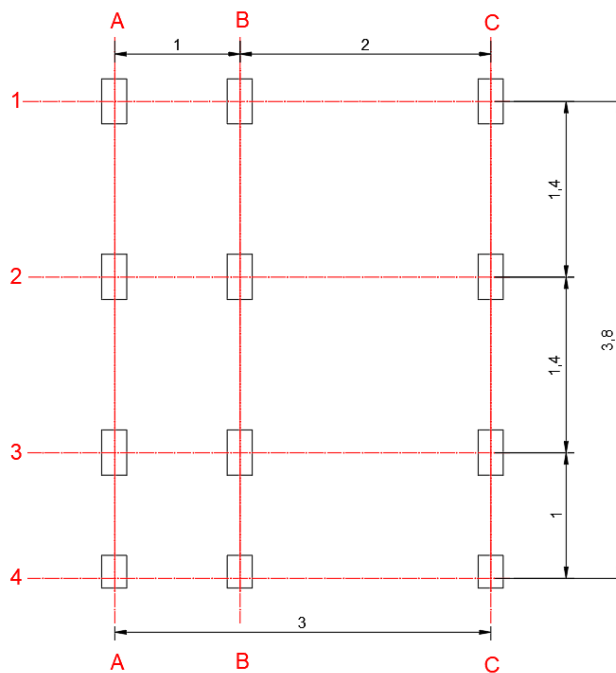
Ejes estructurales vivienda de emergencia. Fuente: Elaboración Propia
